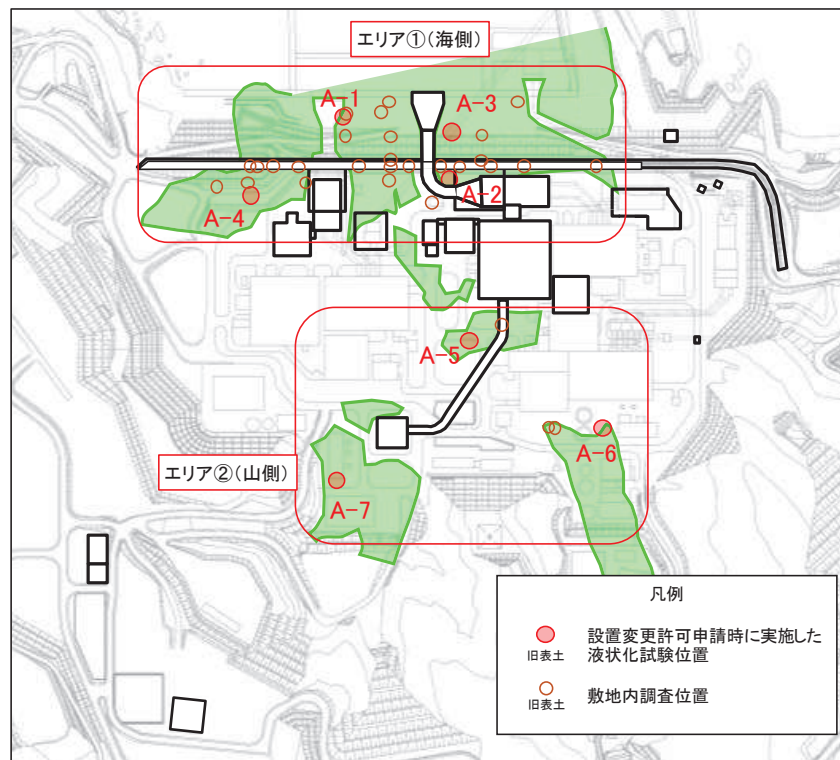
旧表土の液状化強度試験位置及び敷地内調査位置の平面図
